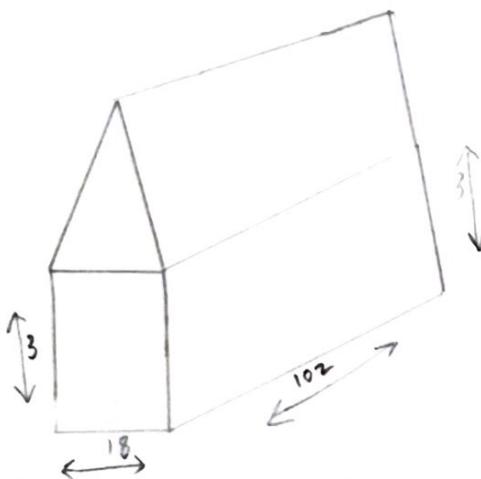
Схематическое изображение здания для расчета монадей ортогональных конструируемых
